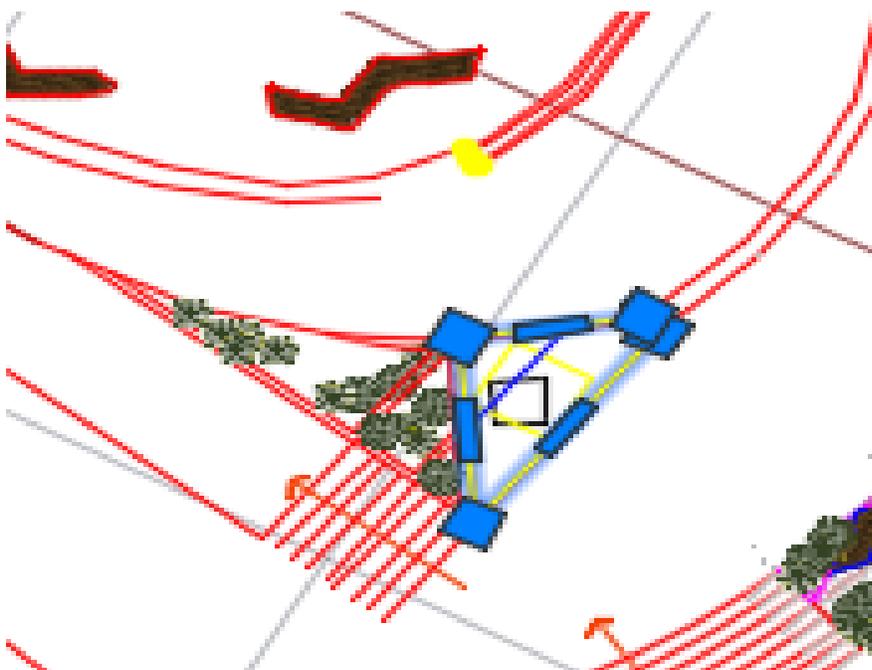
Localización en plano marcado en color azul del muro doble en ladrillo de obra.
